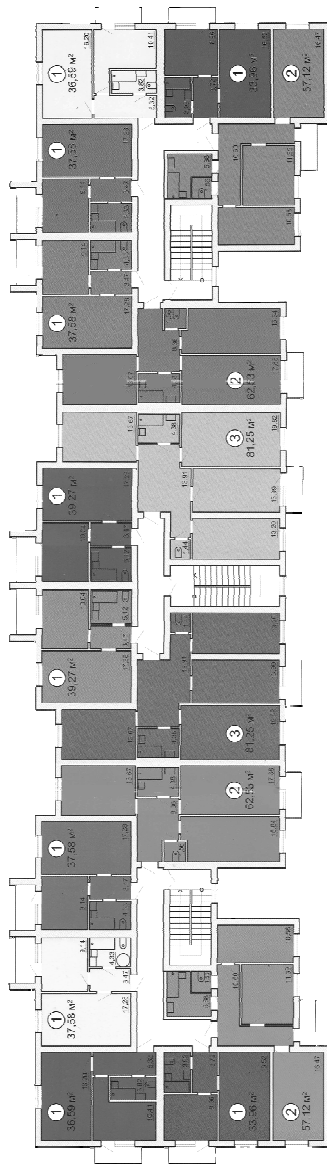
План типового поверху житлового будинку по вул. Чорновола, 93 ж
